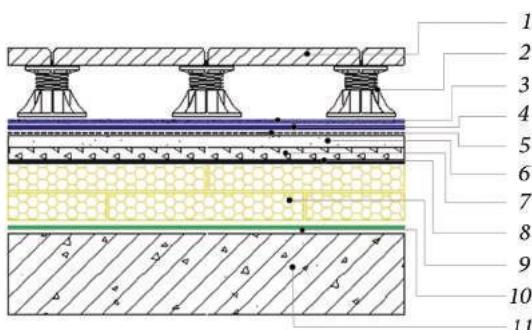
Система традиционной эксплуатируемой кровли с тротуарной плиткой, уложенной на пластиковые винтовые опоры ТН-КРОВЛЯ Терраса:
